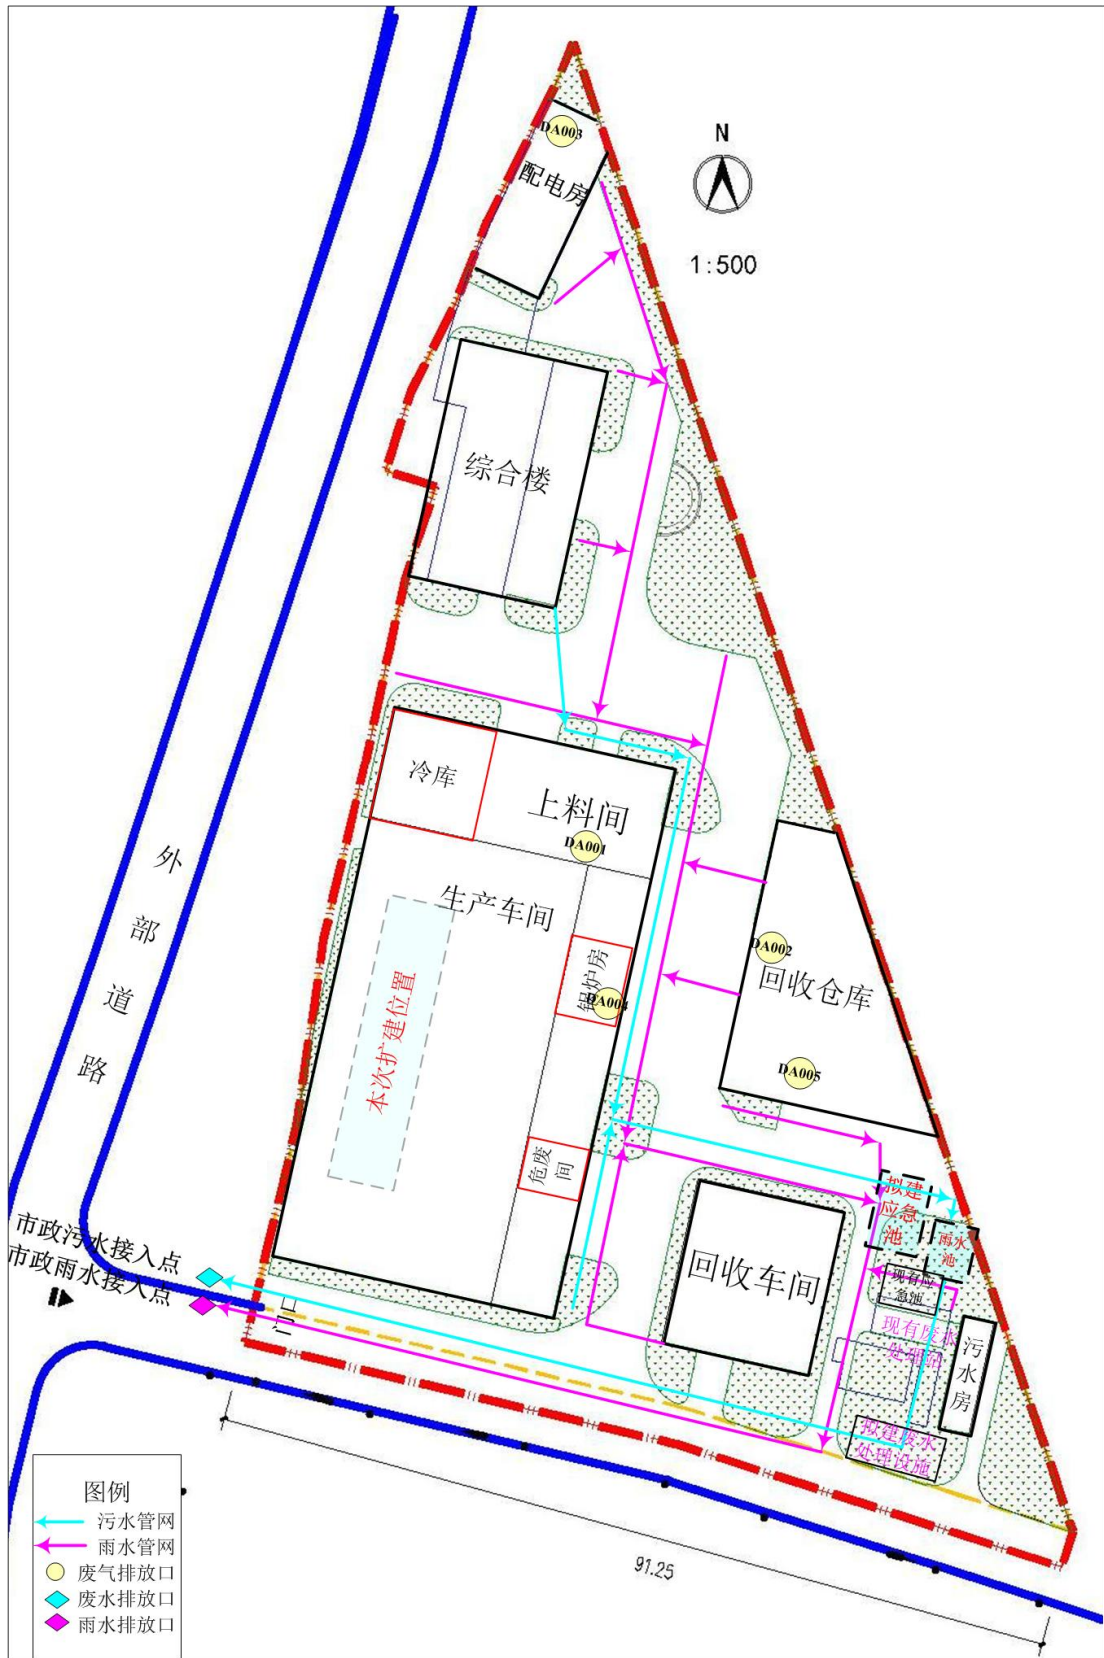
本次改扩建后厂区总体平面布置图
